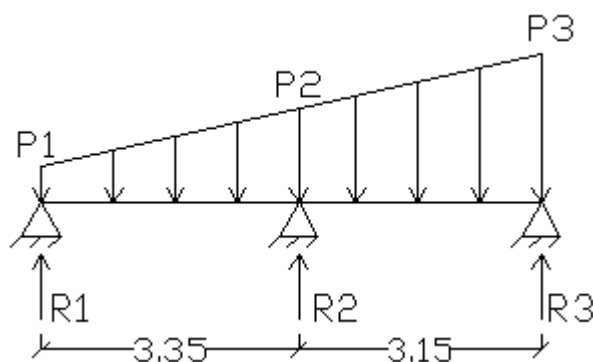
Modelo estrutural Adoptado para o cálculo do Muro de Suporte
